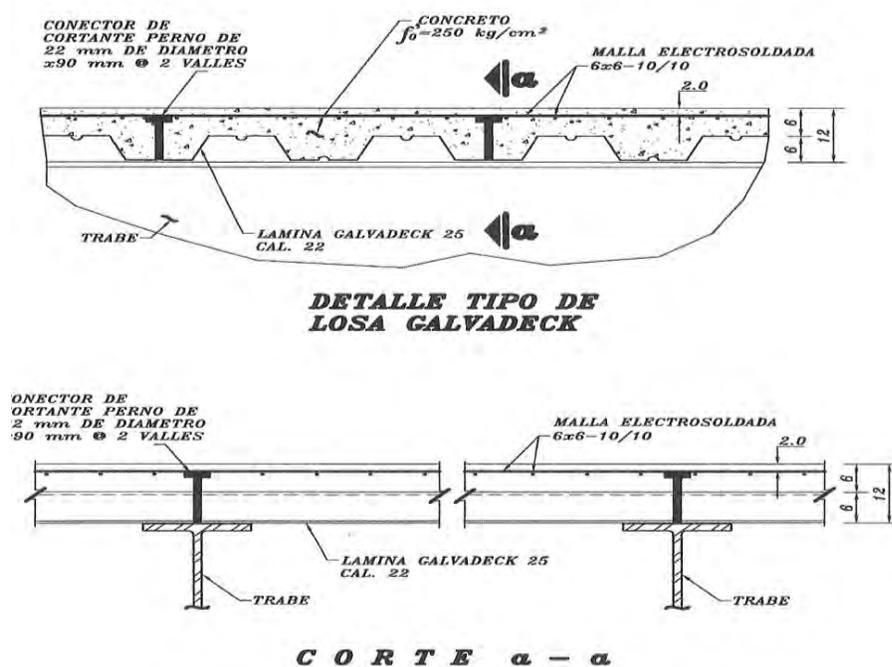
Detalles constructivos. (Imagen de bibliocad.)
